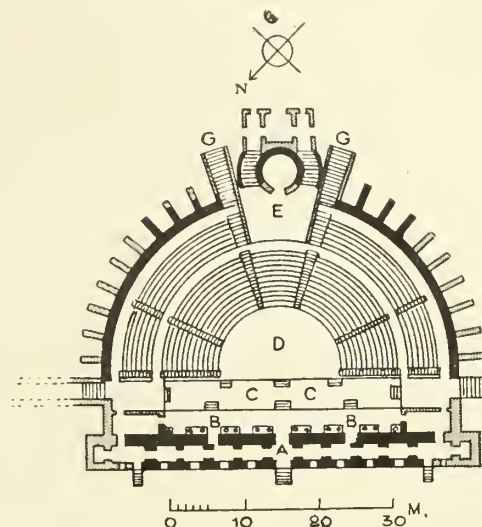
THÉÂTRE DU SUD (VOIR PLAN N° 70)
